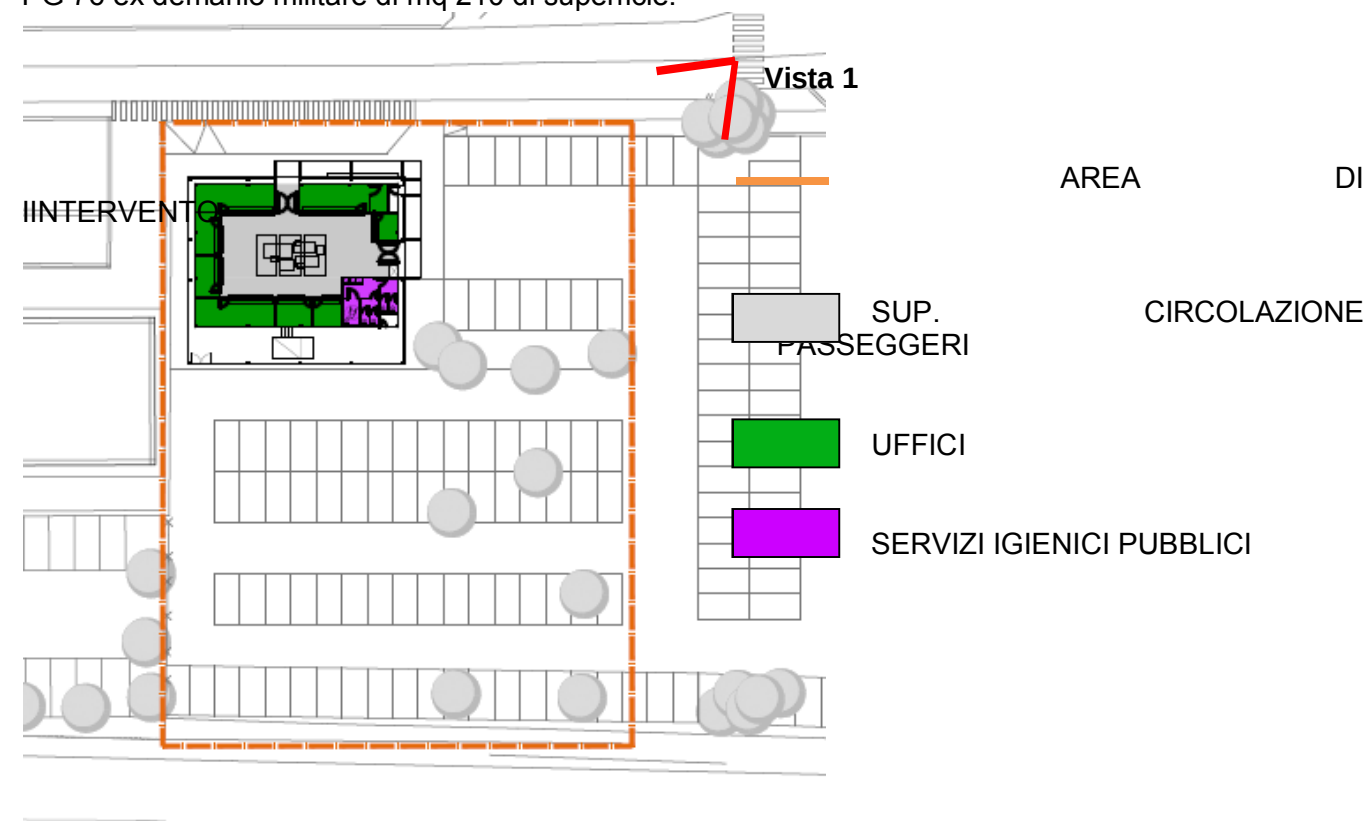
EDIFICIO RENT A CAR : PLANIMETRIA GENERALE
